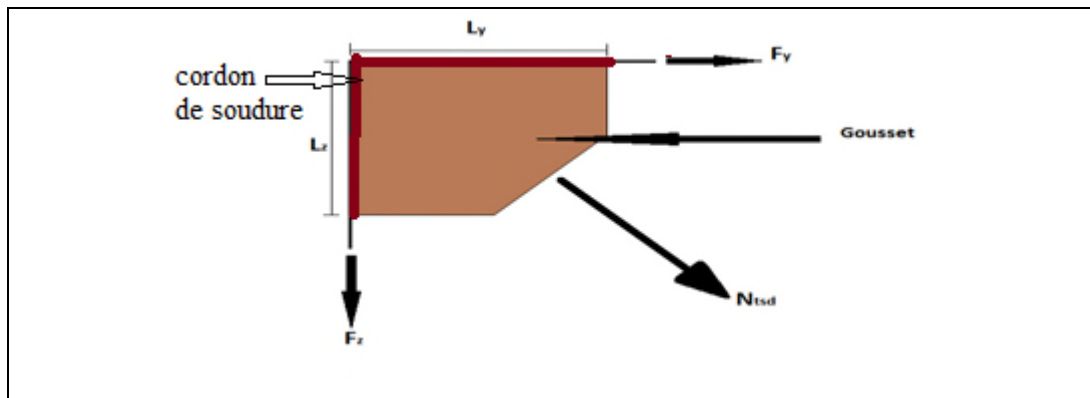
Assemblage gousset nœud du portique par cordon de soudure.
